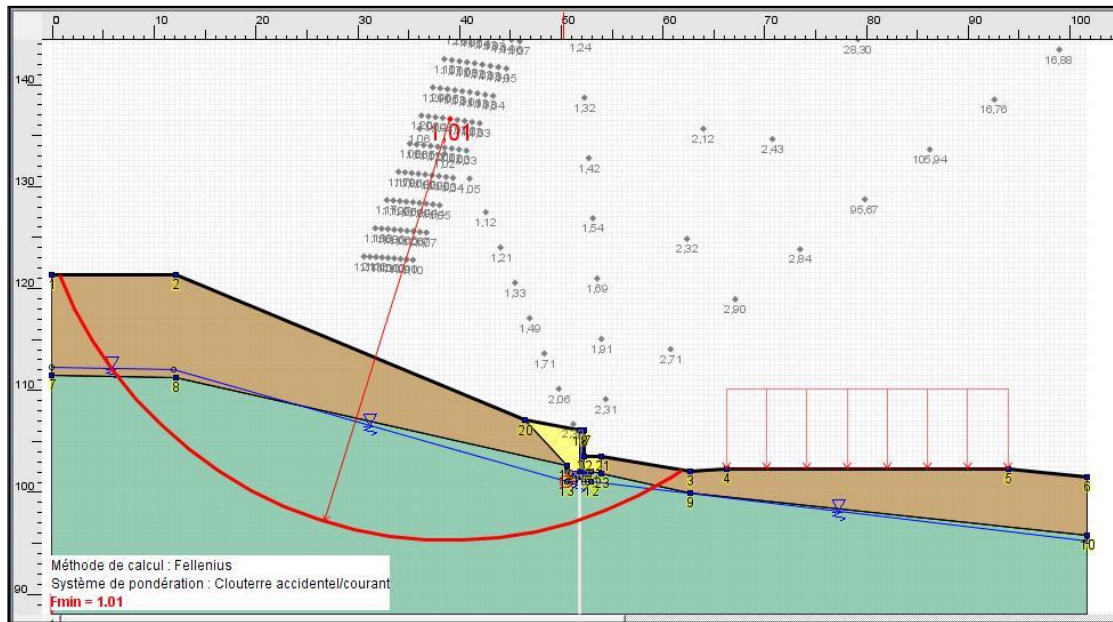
profil type de calcul renforcement par mur sur pieux
